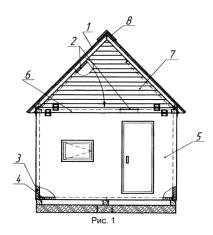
Быстровозводимое здание с двускатной крышей: 1 - крыша; 2 - откидная панель потолка; 3 - боковая панель; 4 - откидная панель пола; 5 - торцевая панель; 6 - поперечная балка; 7 - фронтон; 8 - конек.
